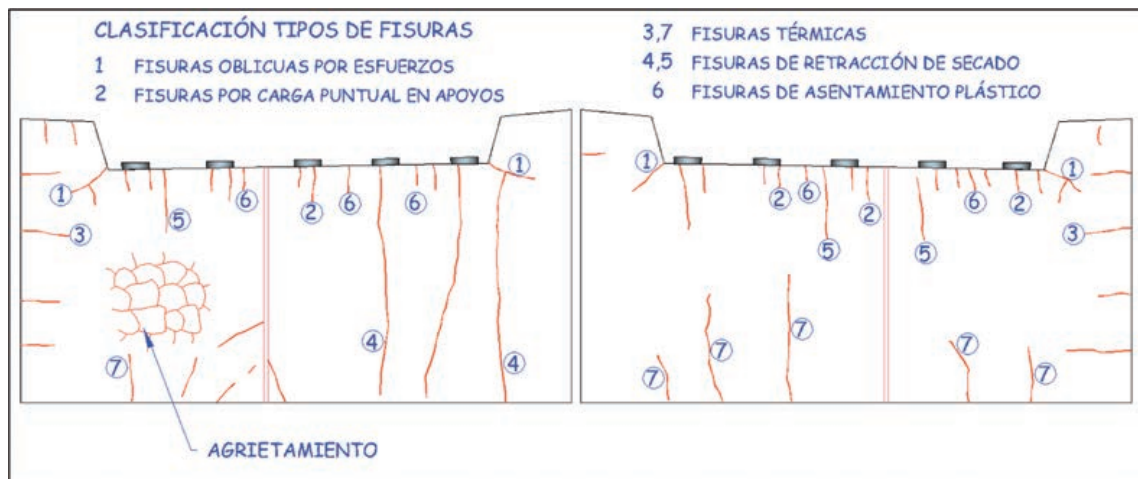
PATRÓN DE FISURACIÓN TÍPICO EN ESTRIBOS DE HORMIGÓN ARMADO
